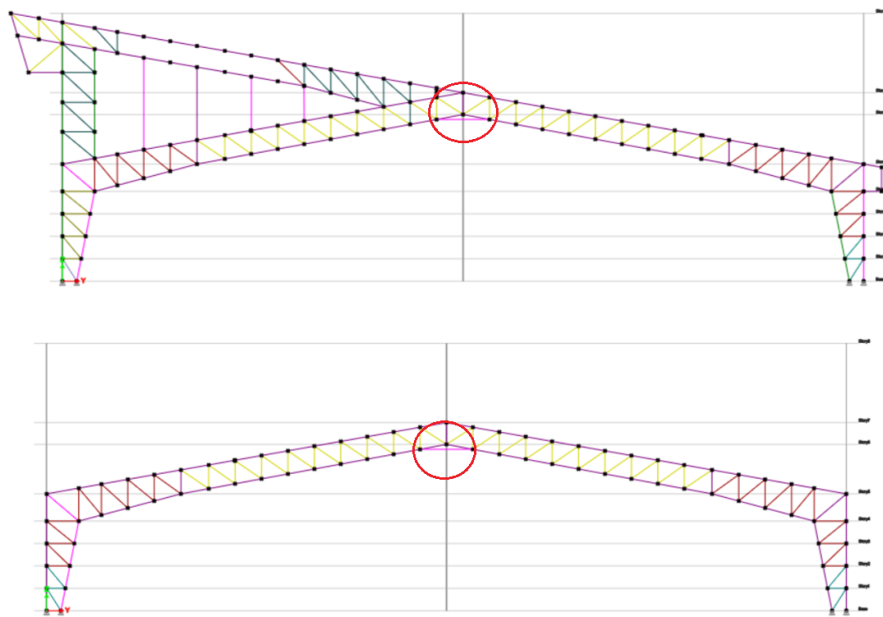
27: Aplicación de reforzamientos en el arco central de la edificación
